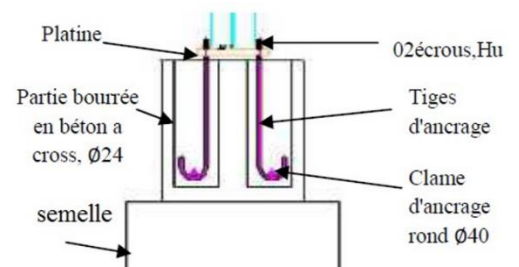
Détail n°01: Articulation pied de poteau-fondation
